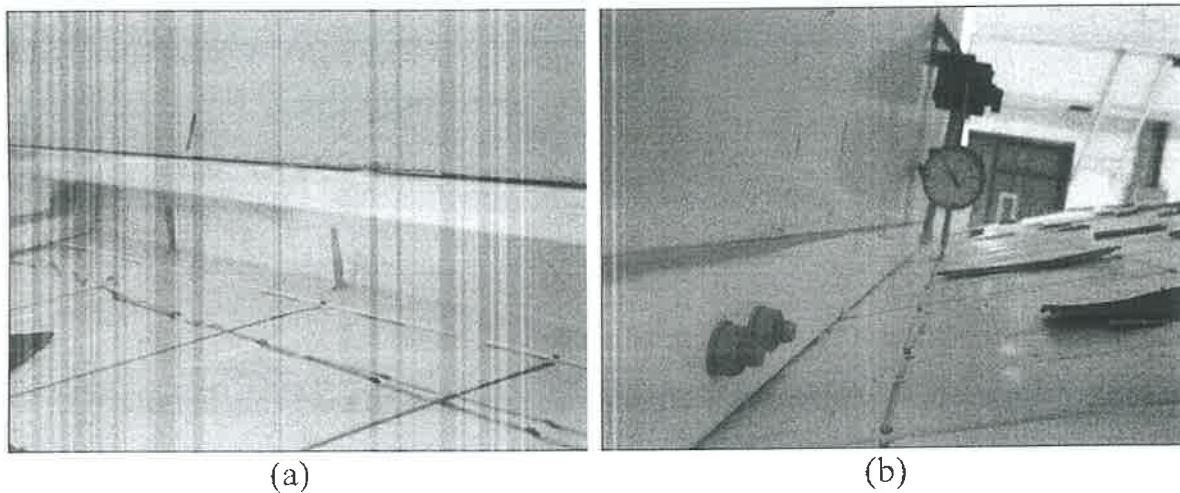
Perfil “G” do Telhado 2 após o descarregamento: (a) vista interna – lado interno da casa e (b) vista externa – lado externo da casa, no beiral.
